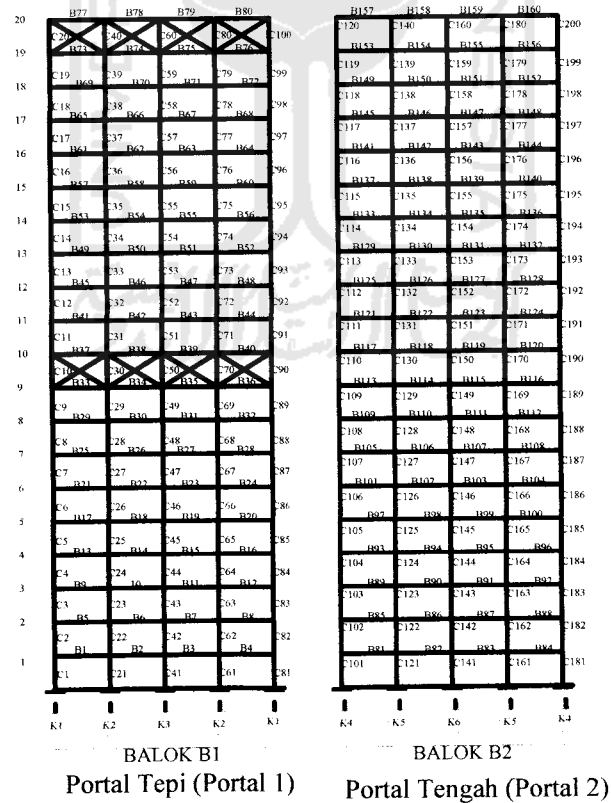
Potongan *Outrigger and Belt truss frame* 20 Lantai 4 *Outrigger
